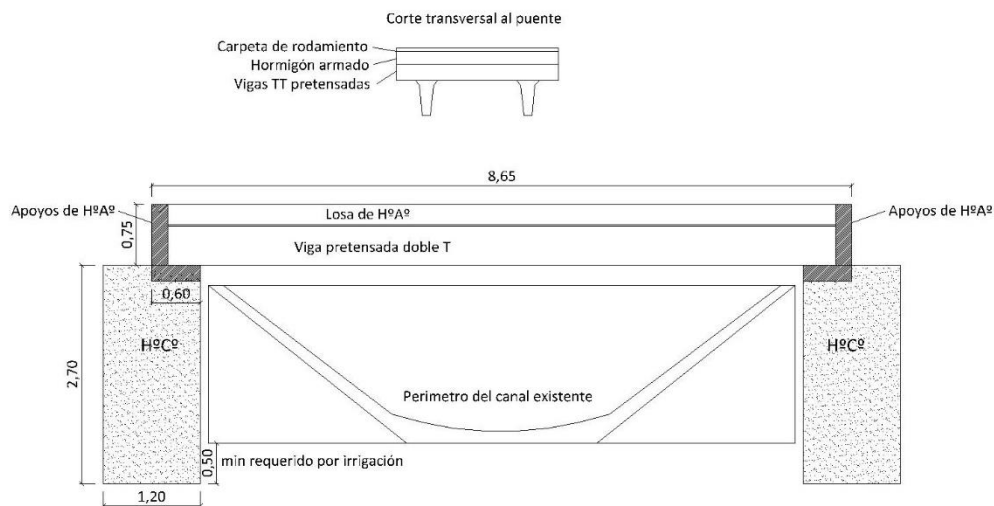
Esquema de estructura de cruce de canal marginal izquierdo con vigas TT pretensadas.
